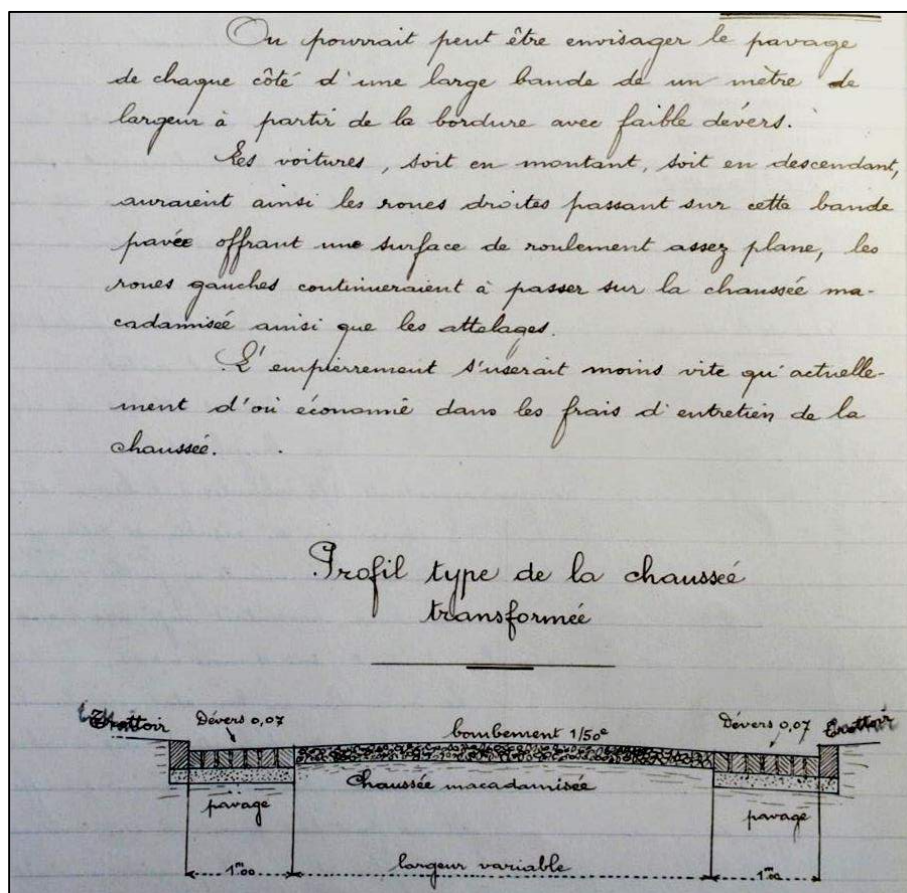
Projet de nouveau revêtement pour la montée de Choulans, 24 septembre 1925 (ADR 2047 W 9)
